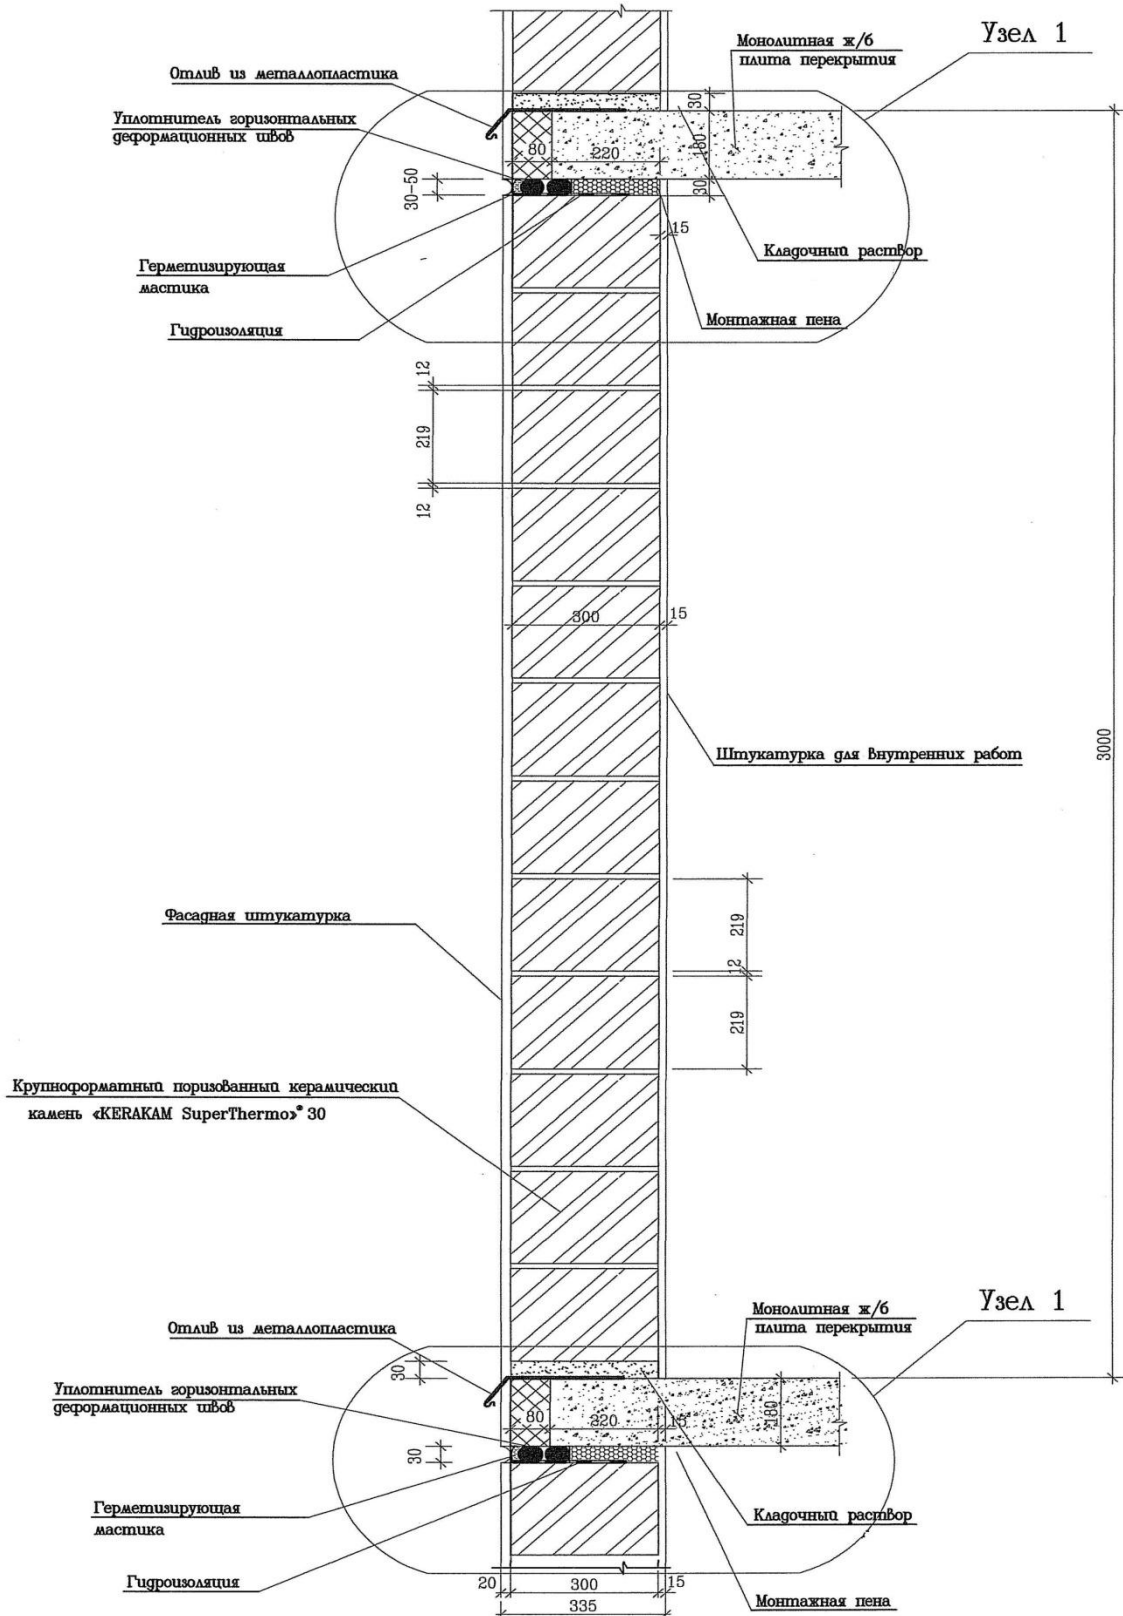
Разрез оштукатуренной стены без проемов.
